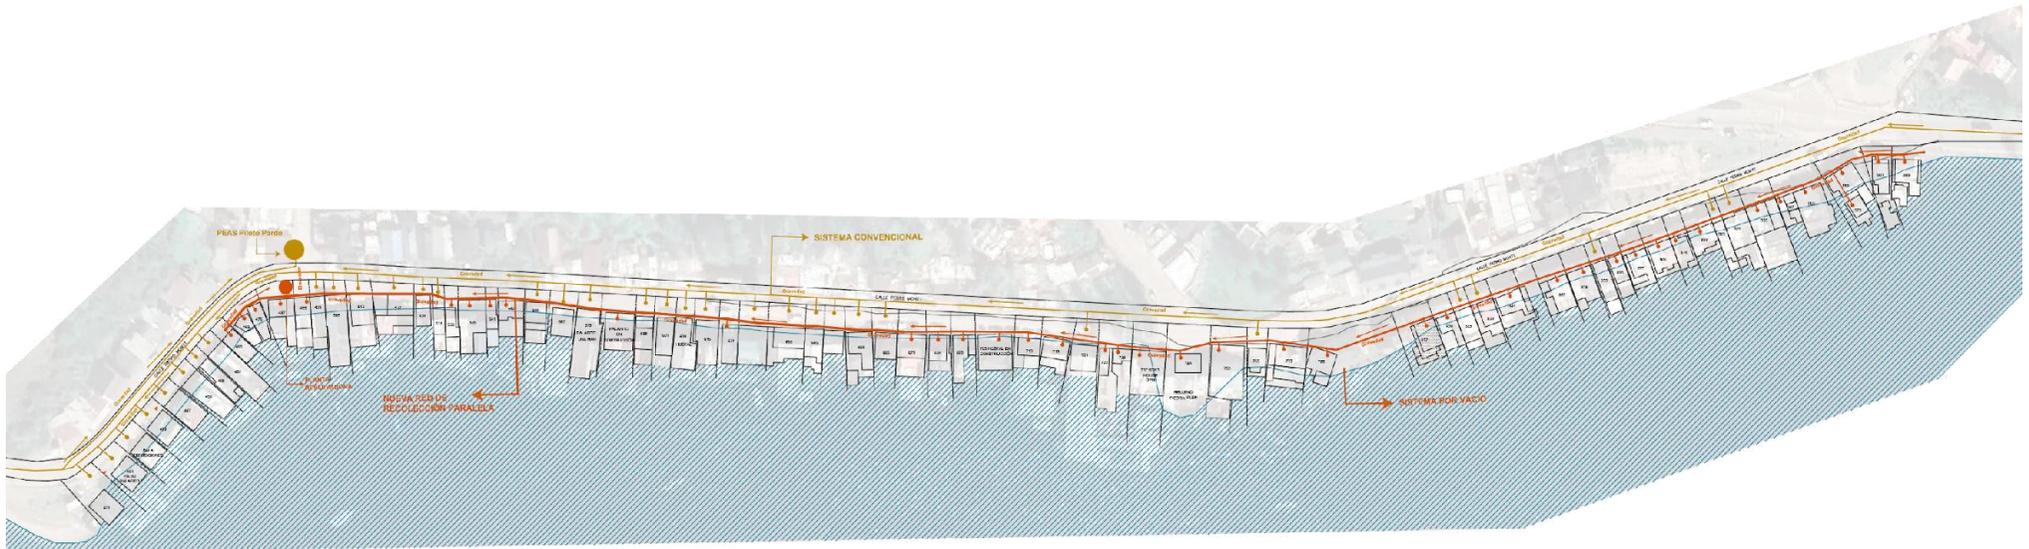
Planta conjunta palafítico P.Montt 1 con propuesta esquemática de solución por incorporación de red paralela y planta reelevadora.
